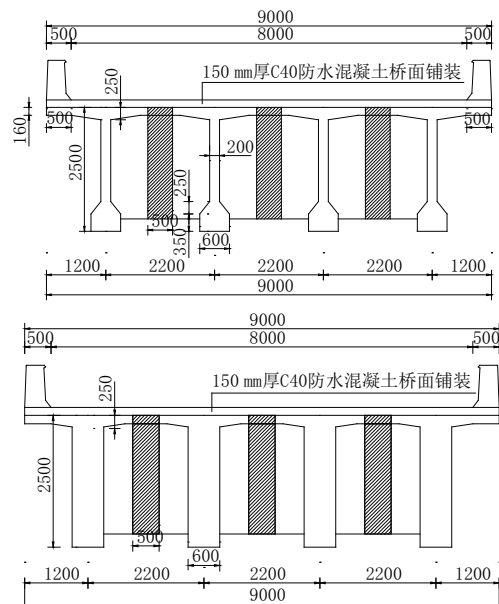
桥梁跨中及支点横断面布置图(单位:mm)
